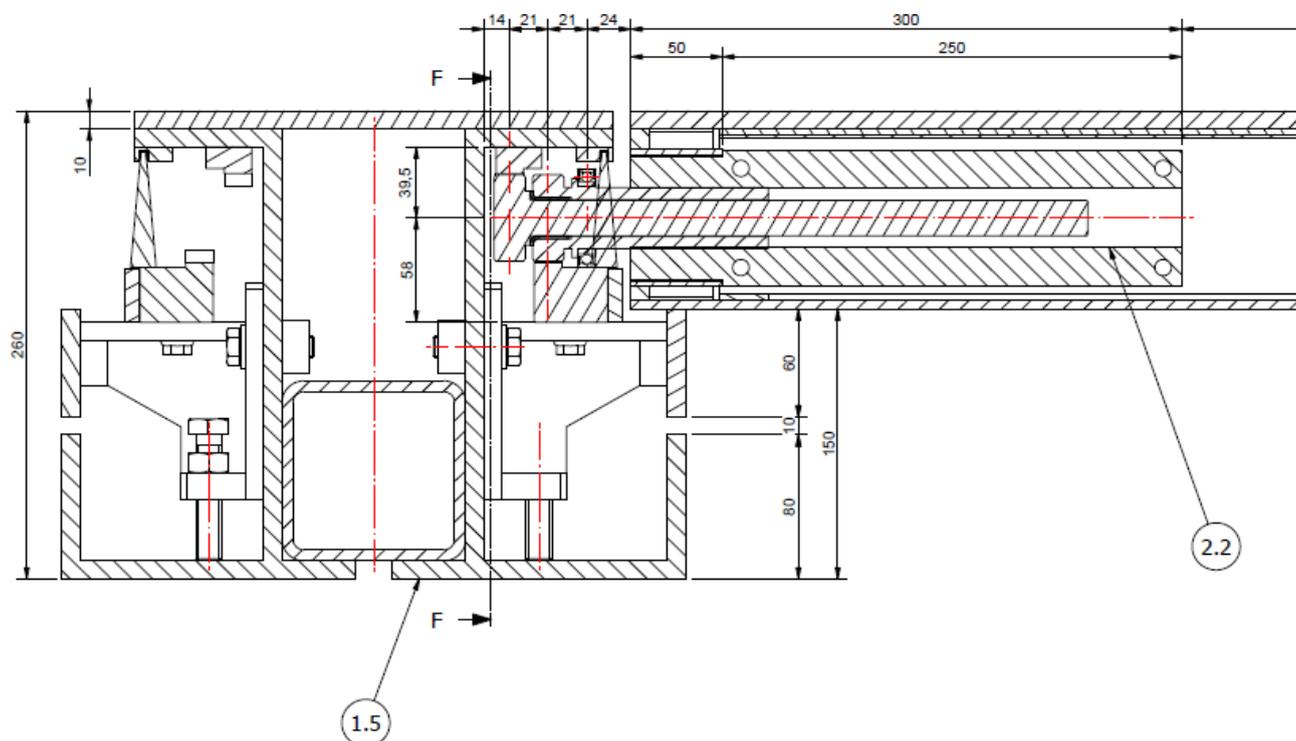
Sezione integrata avente funzione strutturale e impiantistica
